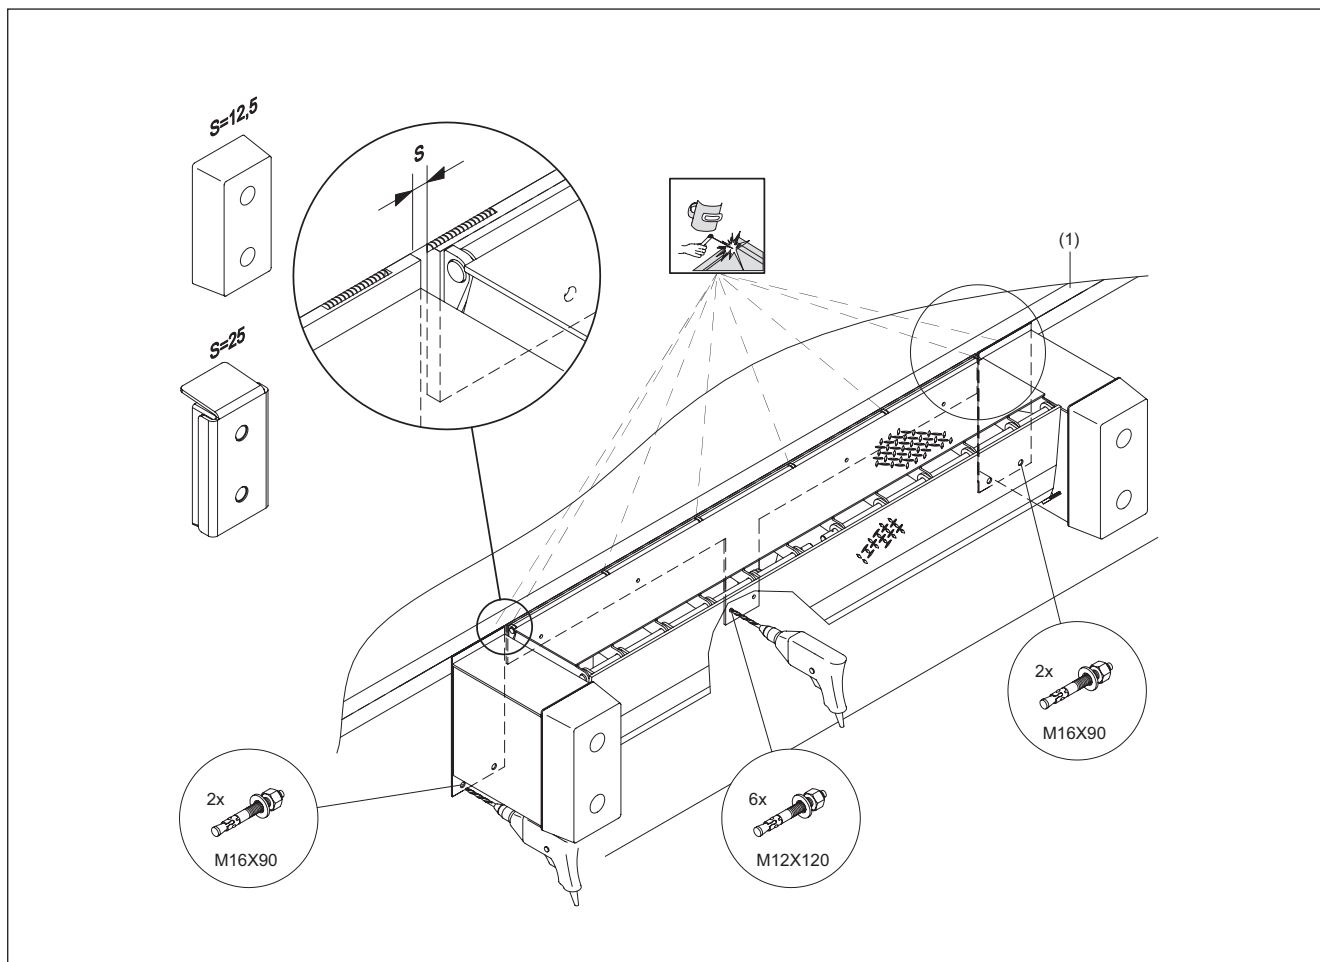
Конструкция MRS-V для монтажа сваркой перед зданием
